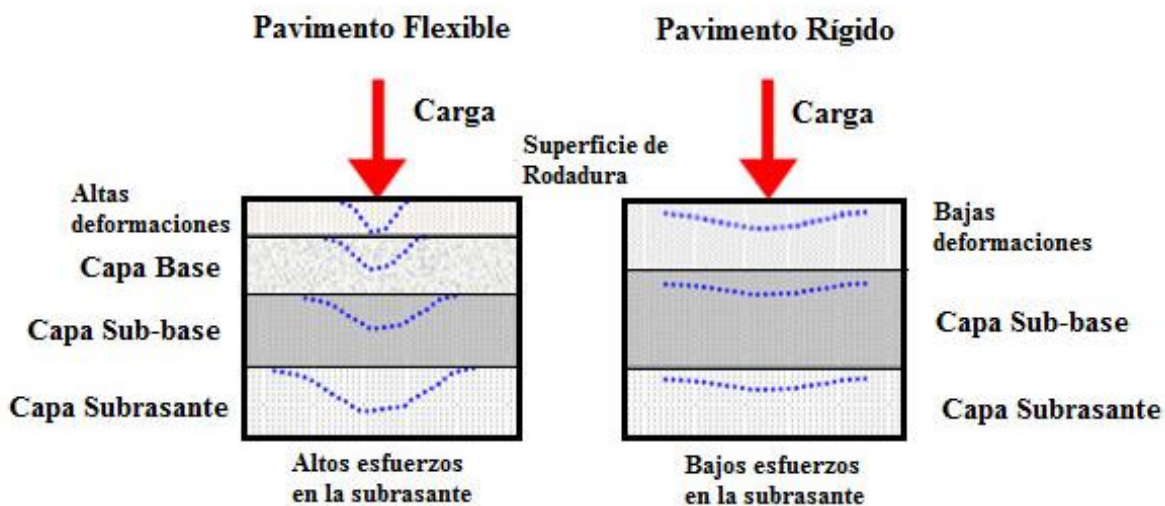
Comportamiento de los pavimentos flexibles y rígidos ante una carga.
